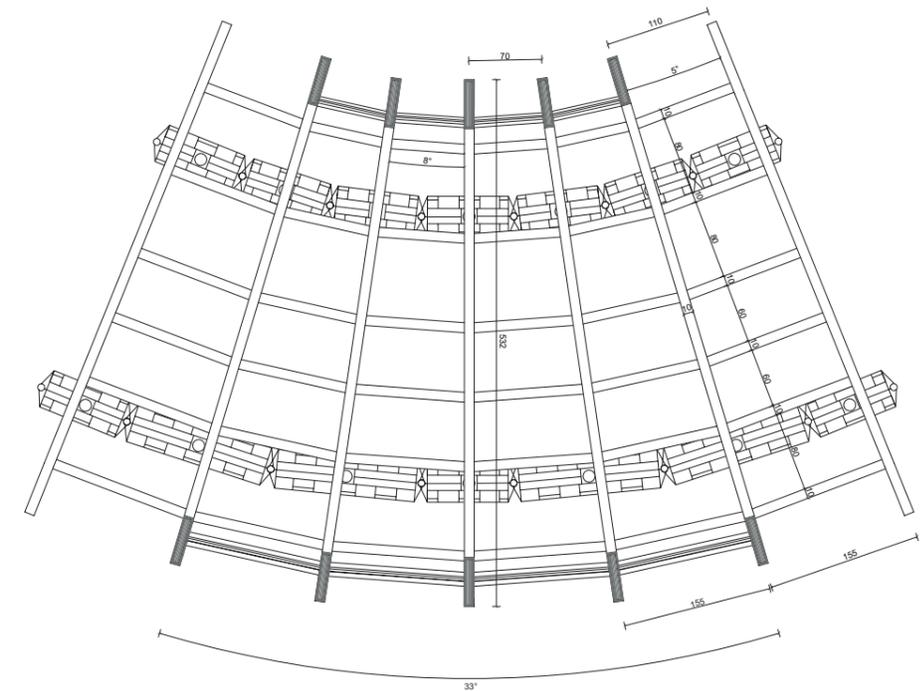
PIANTE STRUTTURALE FONDAZIONI JERSEY
